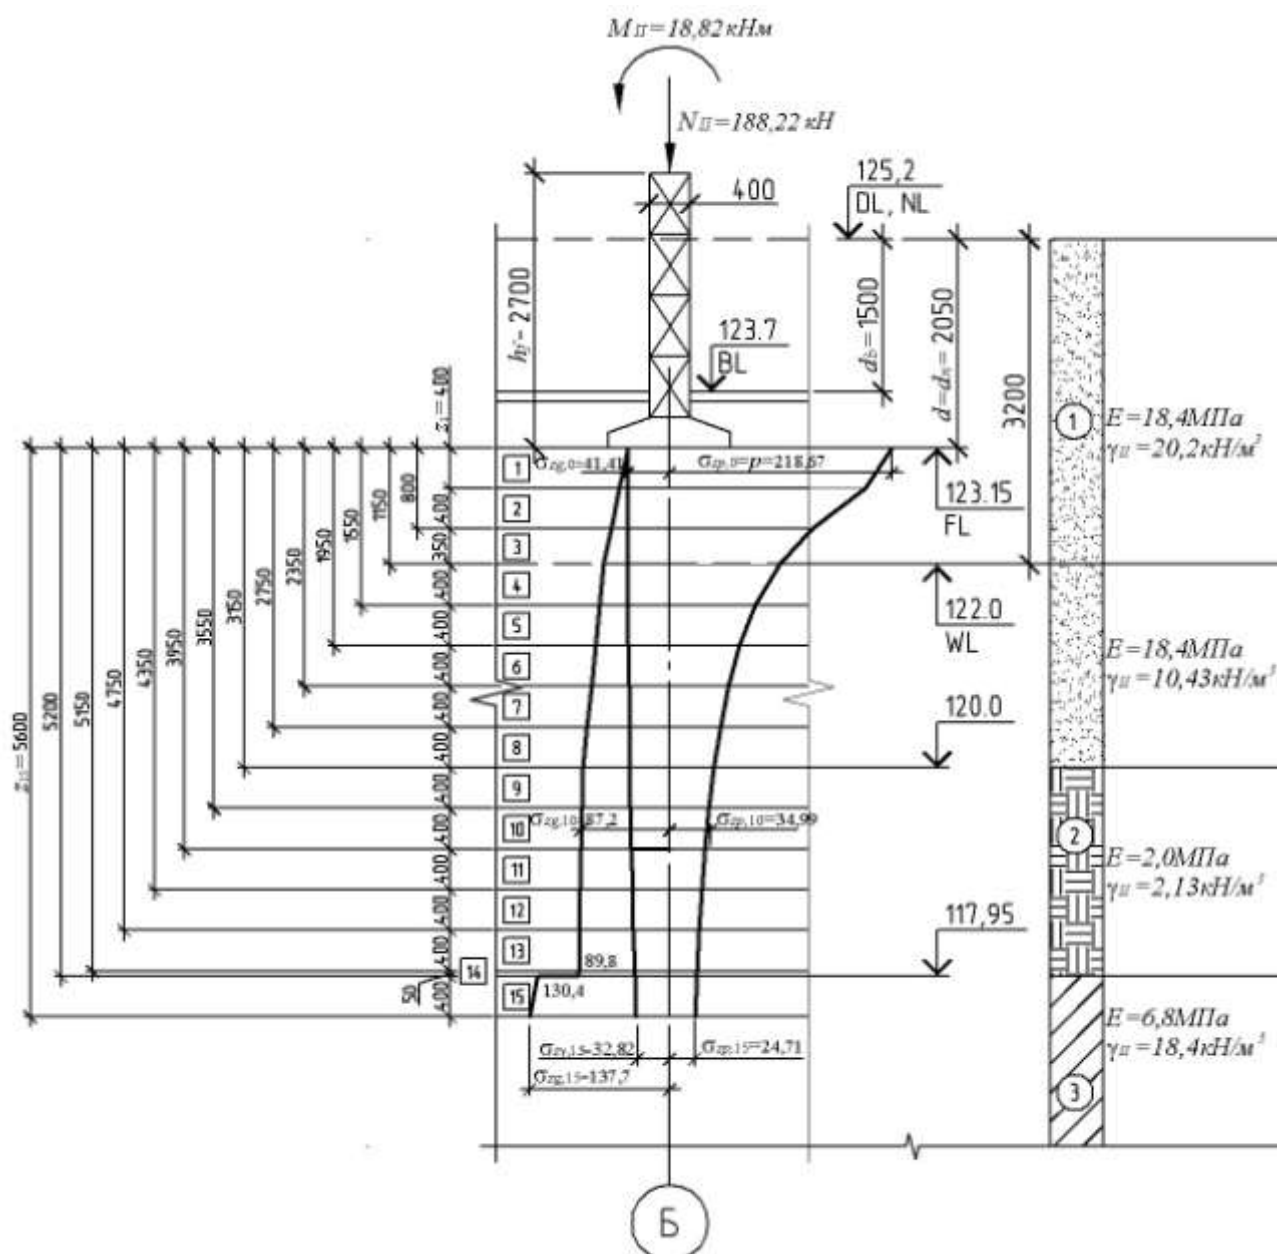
Расчетная схема для определения осадки к примеру 7.7.1
